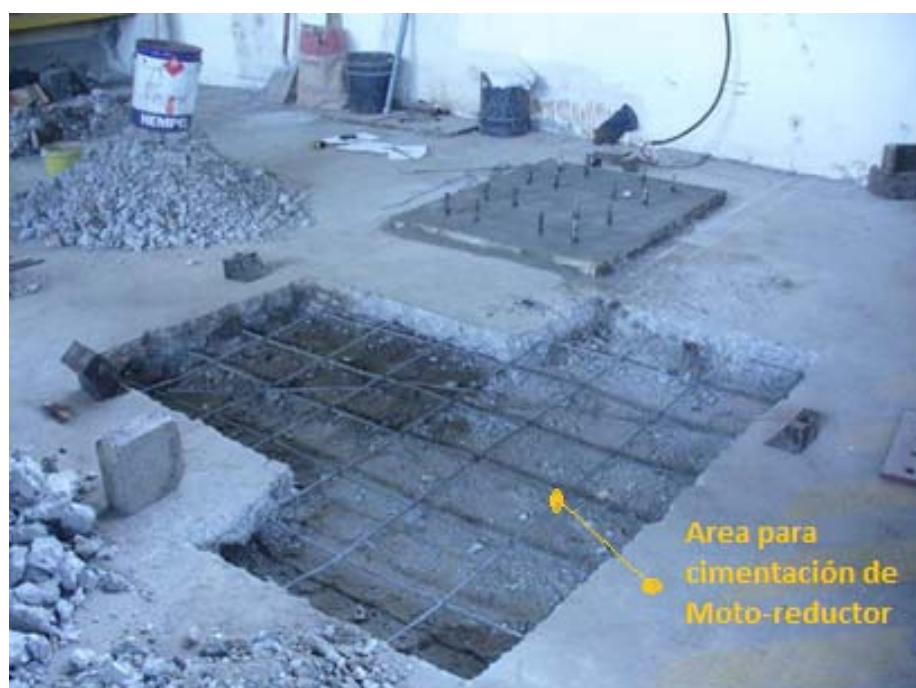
AREA PARA CONSTRUCCIÓN DE CIMENTACIÓN
